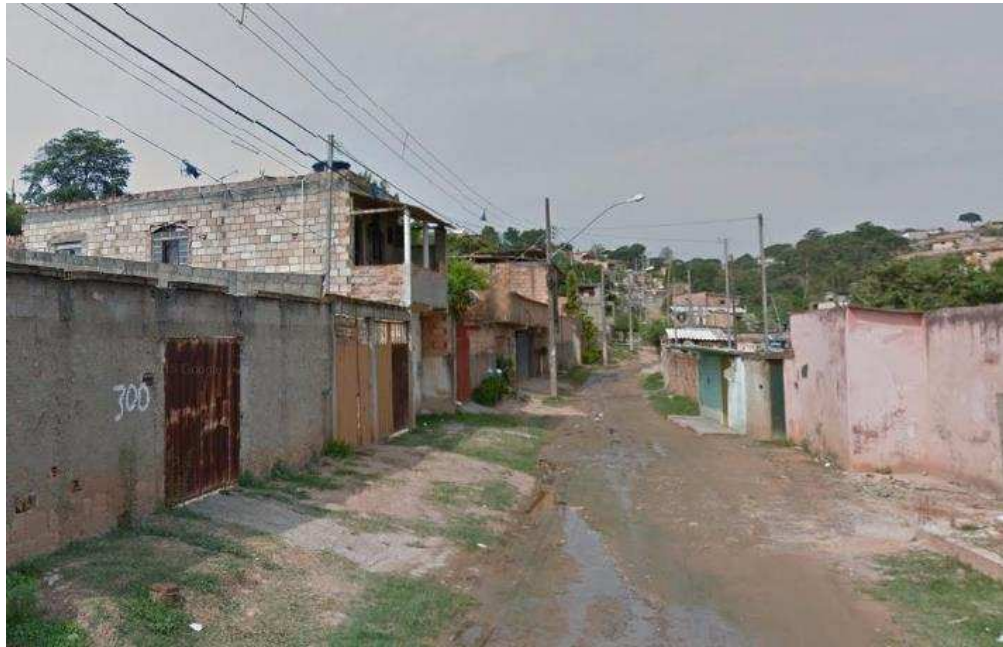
Vista da Rua dos Capuchinhos, Bairro Rosaneves. Sede. Aprovado em 1986. Observa-se na figura a ausência de pavimentação e drenagem pluvial. Fonte: Arquivo Pessoal. 2015.
